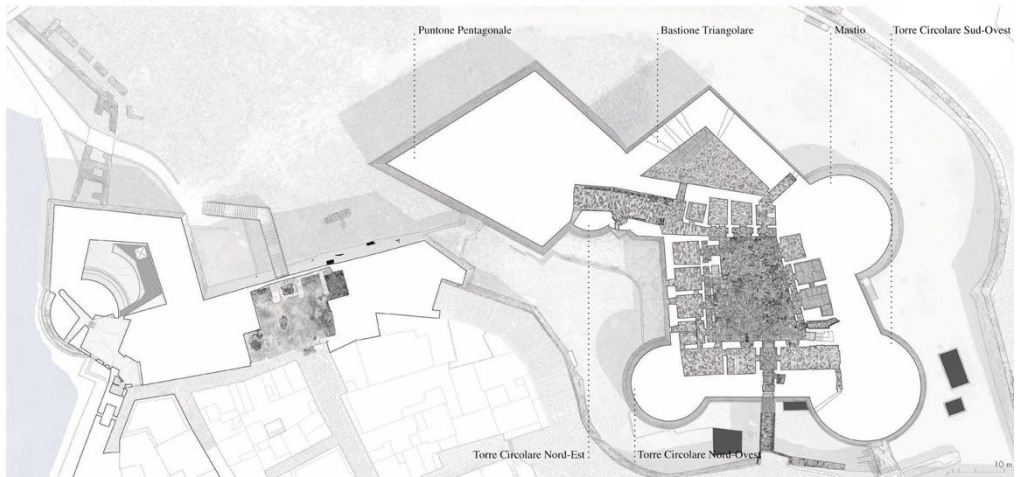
Otranto, il castello. Pianta a quota + 16,03 m (Baldassarre, V. et alii 2018)
